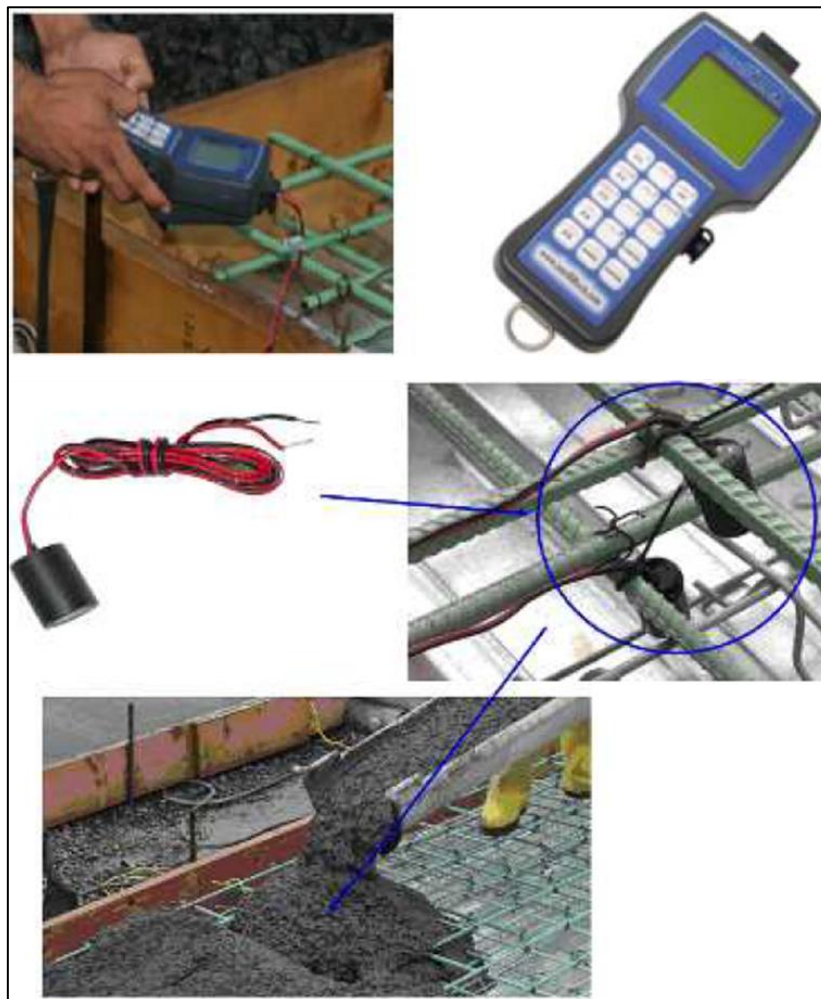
Colocación de termocuplas en las estructuras de concreto armado (Fuente: Internet)
